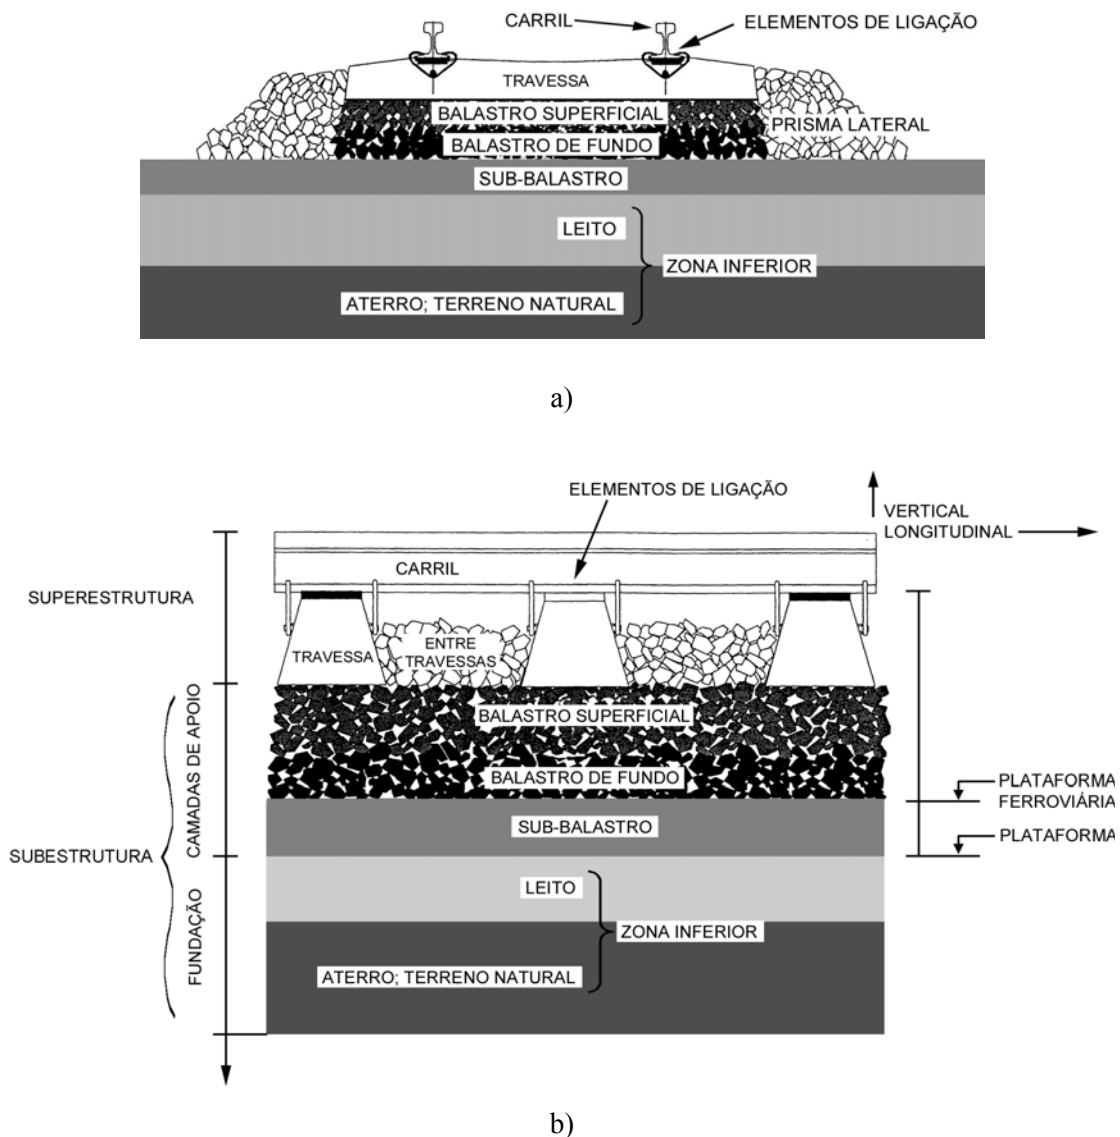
Esquema estrutural da via balastrada: a) perfil transversal; b) perfil longitudinal (Fortunato, 2005)
